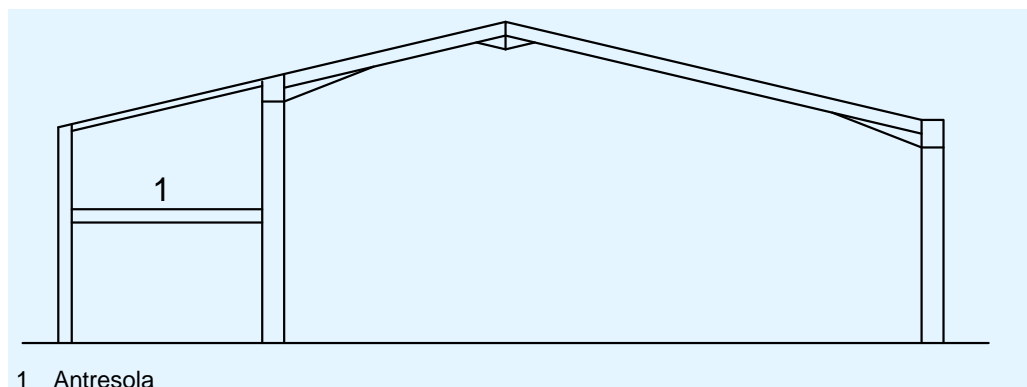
Rama portalowa z wewnętrznym stropem międzykondygnacyjnym
